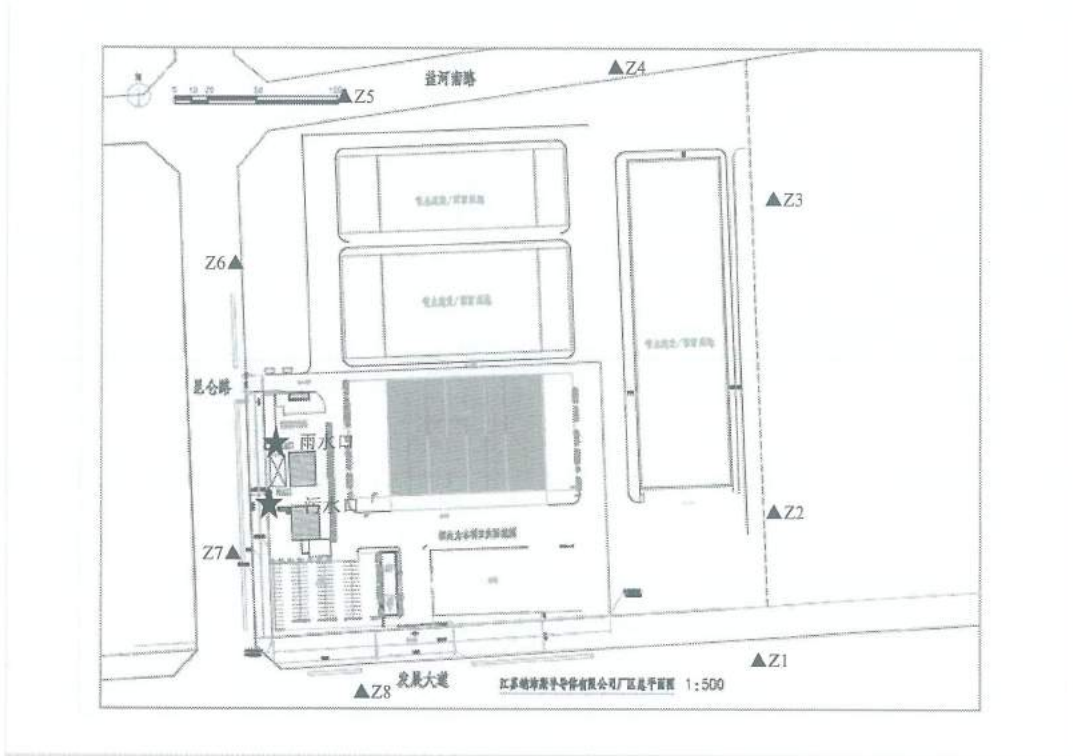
项目总平面布置（含雨水、污水、噪声监测点位）
